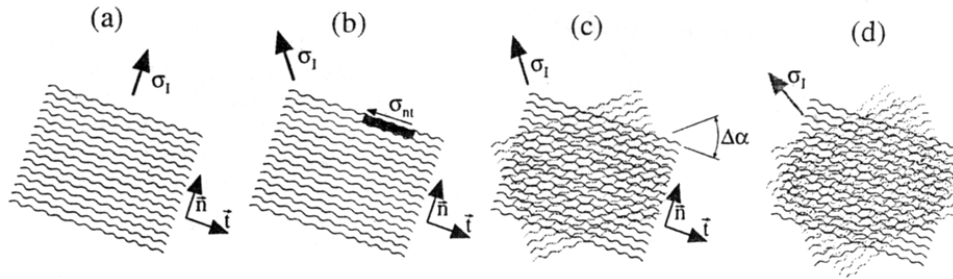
Múltiplas fissuras (BAŽANT, 1997): (a) fissura primária; (b) tensões de cisalhamento provenientes da rotação dos eixos principais; (c) fissura secundária; (d) fissura terciária
